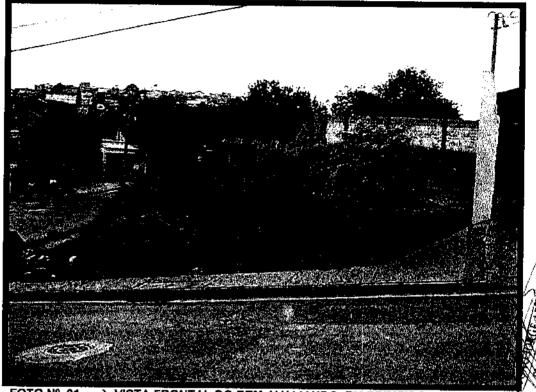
→ VISTA FRONTAL DO BEM AVALIANDO. EM PRIMEIRO PLANO A RUA-PRIMO FILIPPINI
